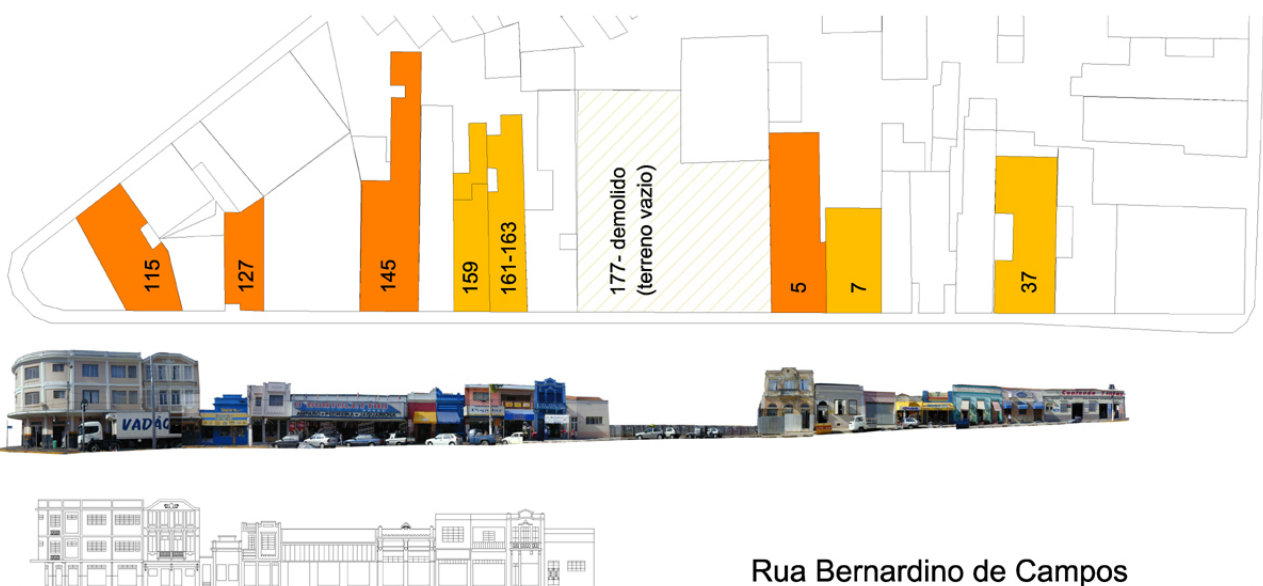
Elevação da Rua Bernardino de Campos, em frente Edifício da Estação.
